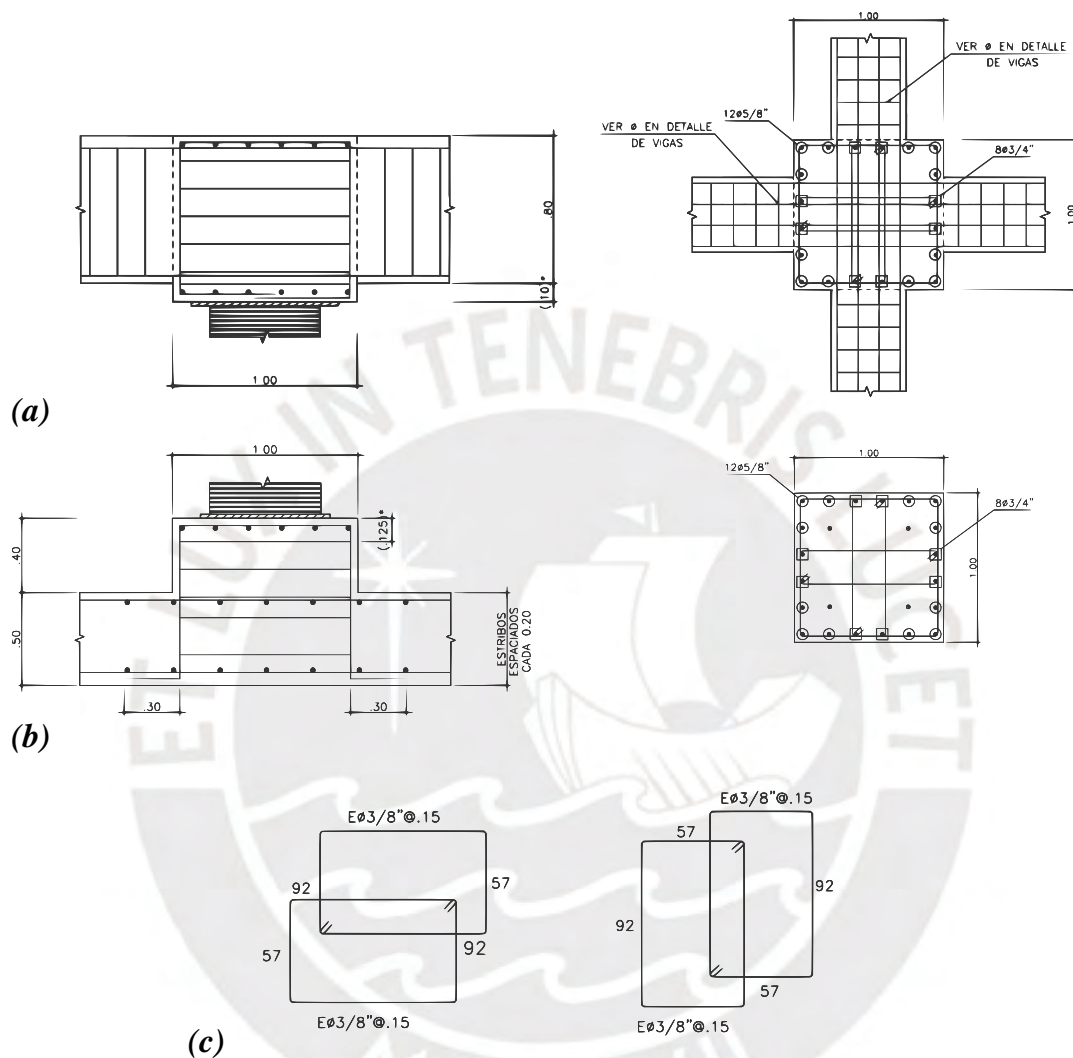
Detalles del armado del acero de refuerzo para conexión con aislador elastomérico: a) vista en elevación y en planta del capitel; b) vista en elevación y en planta del pedestal; y c) juego de estribos.
